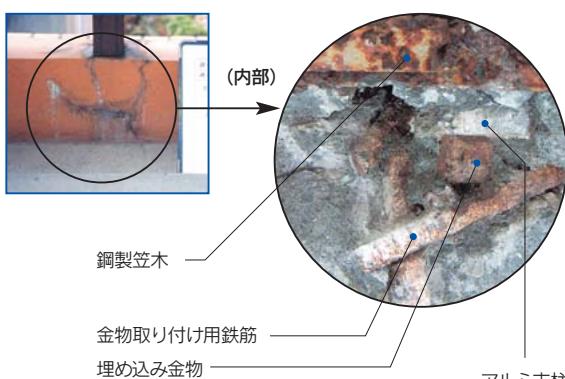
：支柱埋め込み部におけるひび割れと内部の状況
